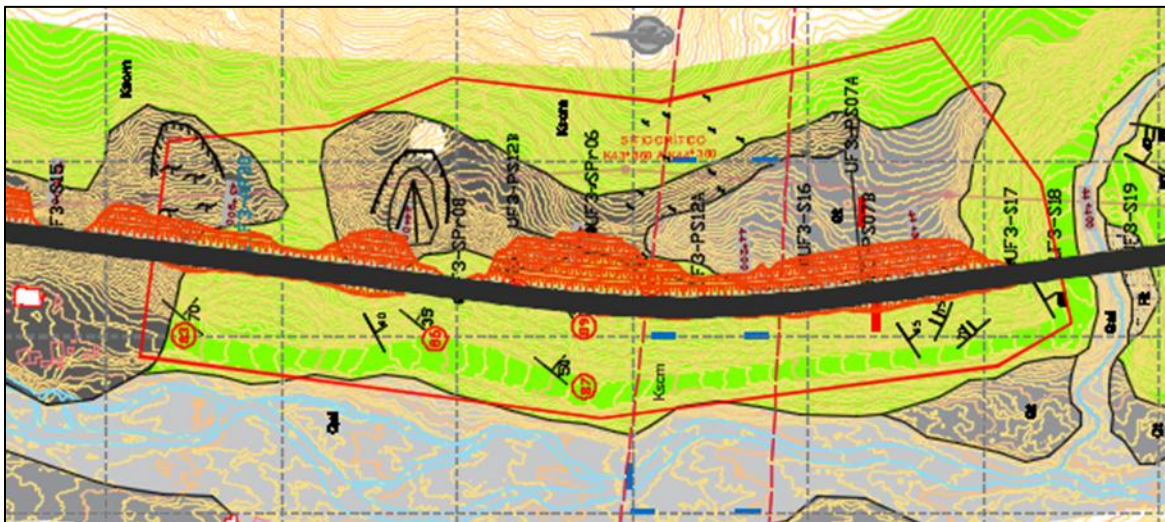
Vista en planta de la Geología del sitio crítico 7. (Fuente: Elaboración propia).
